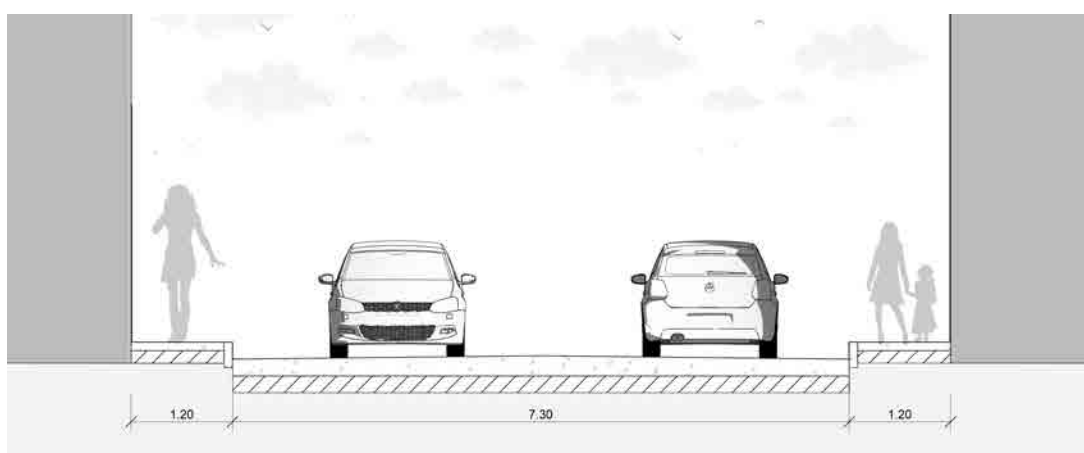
Sección. Fuente y elaboración: Autores.
